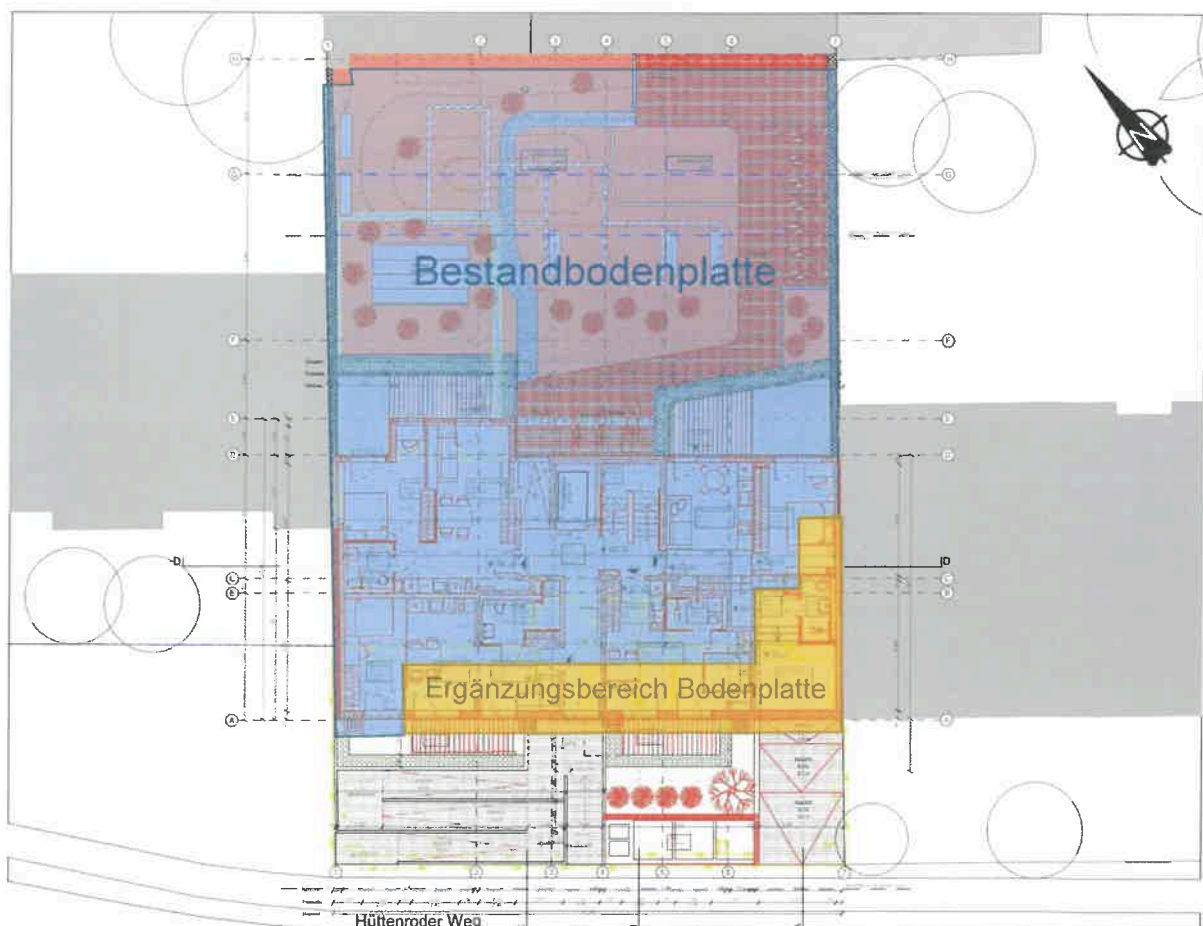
Lageplan mit Bestandsbodenplatte (blau) und zu ergänzendem Bereich (gelb) [U 2]
